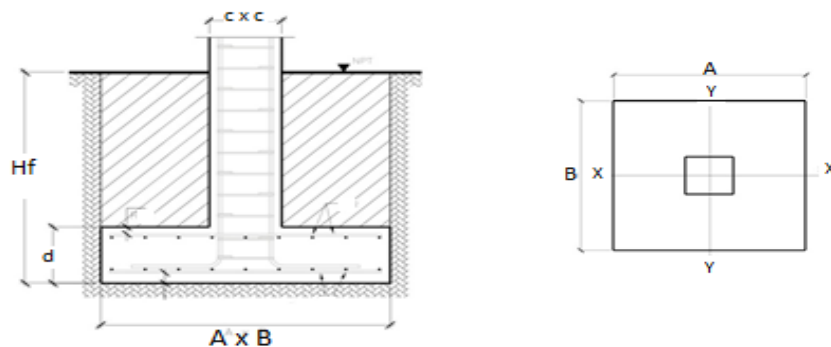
Detallado de acero de refuerzo en la losa de cimentación
